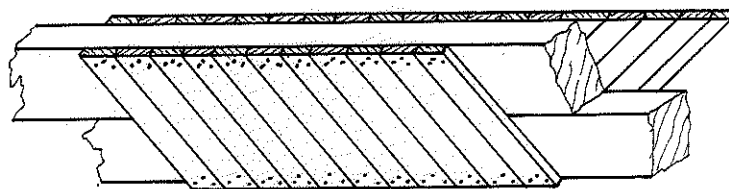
Viga com elementos interligados por meio de tábuas e pregos - Viga Clark
